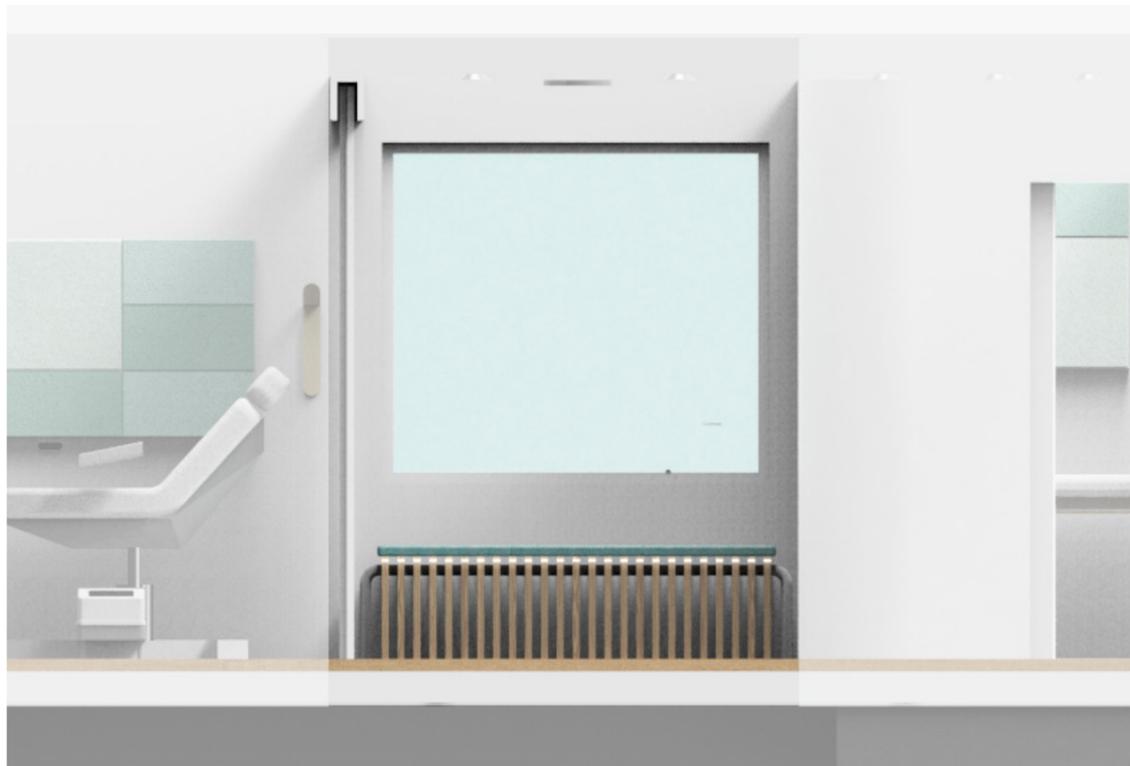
Prospetto sinistro nuova sala d'attesa pre-donazione
